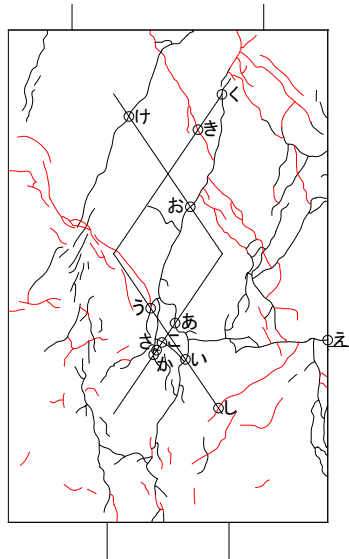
パイルキャップひび割れ幅測定位置 (試験体 A-7b 正載荷)
